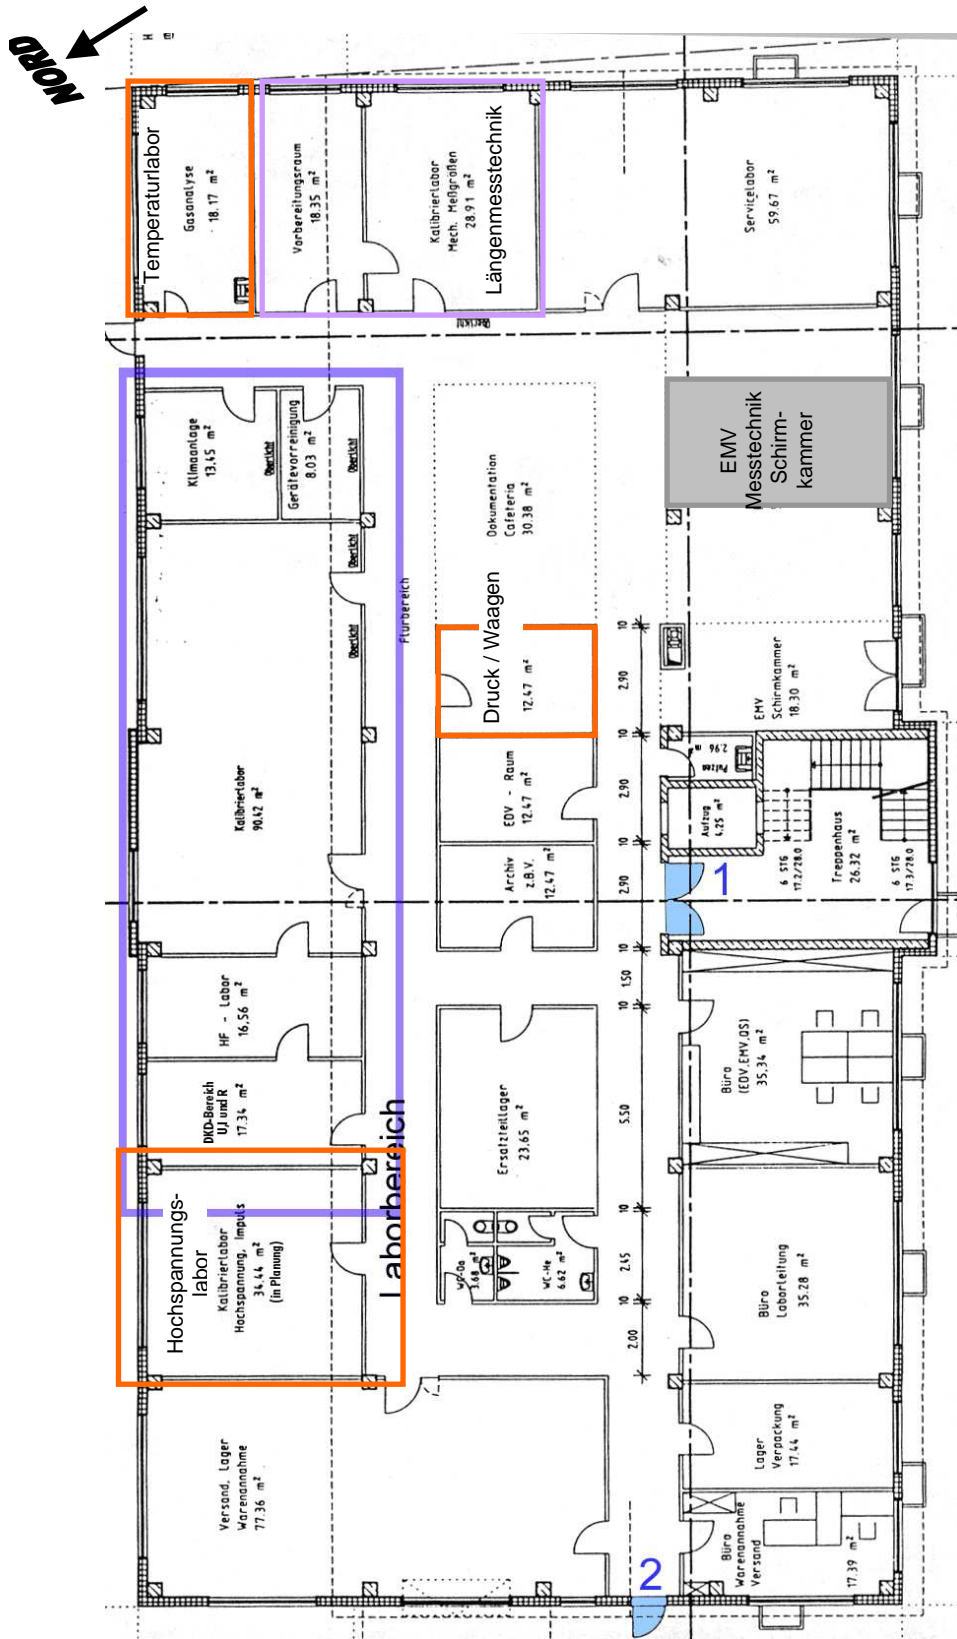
Raumplan esz AG, Erdgeschoss – 1 und 2: Zutrittskontrolle
